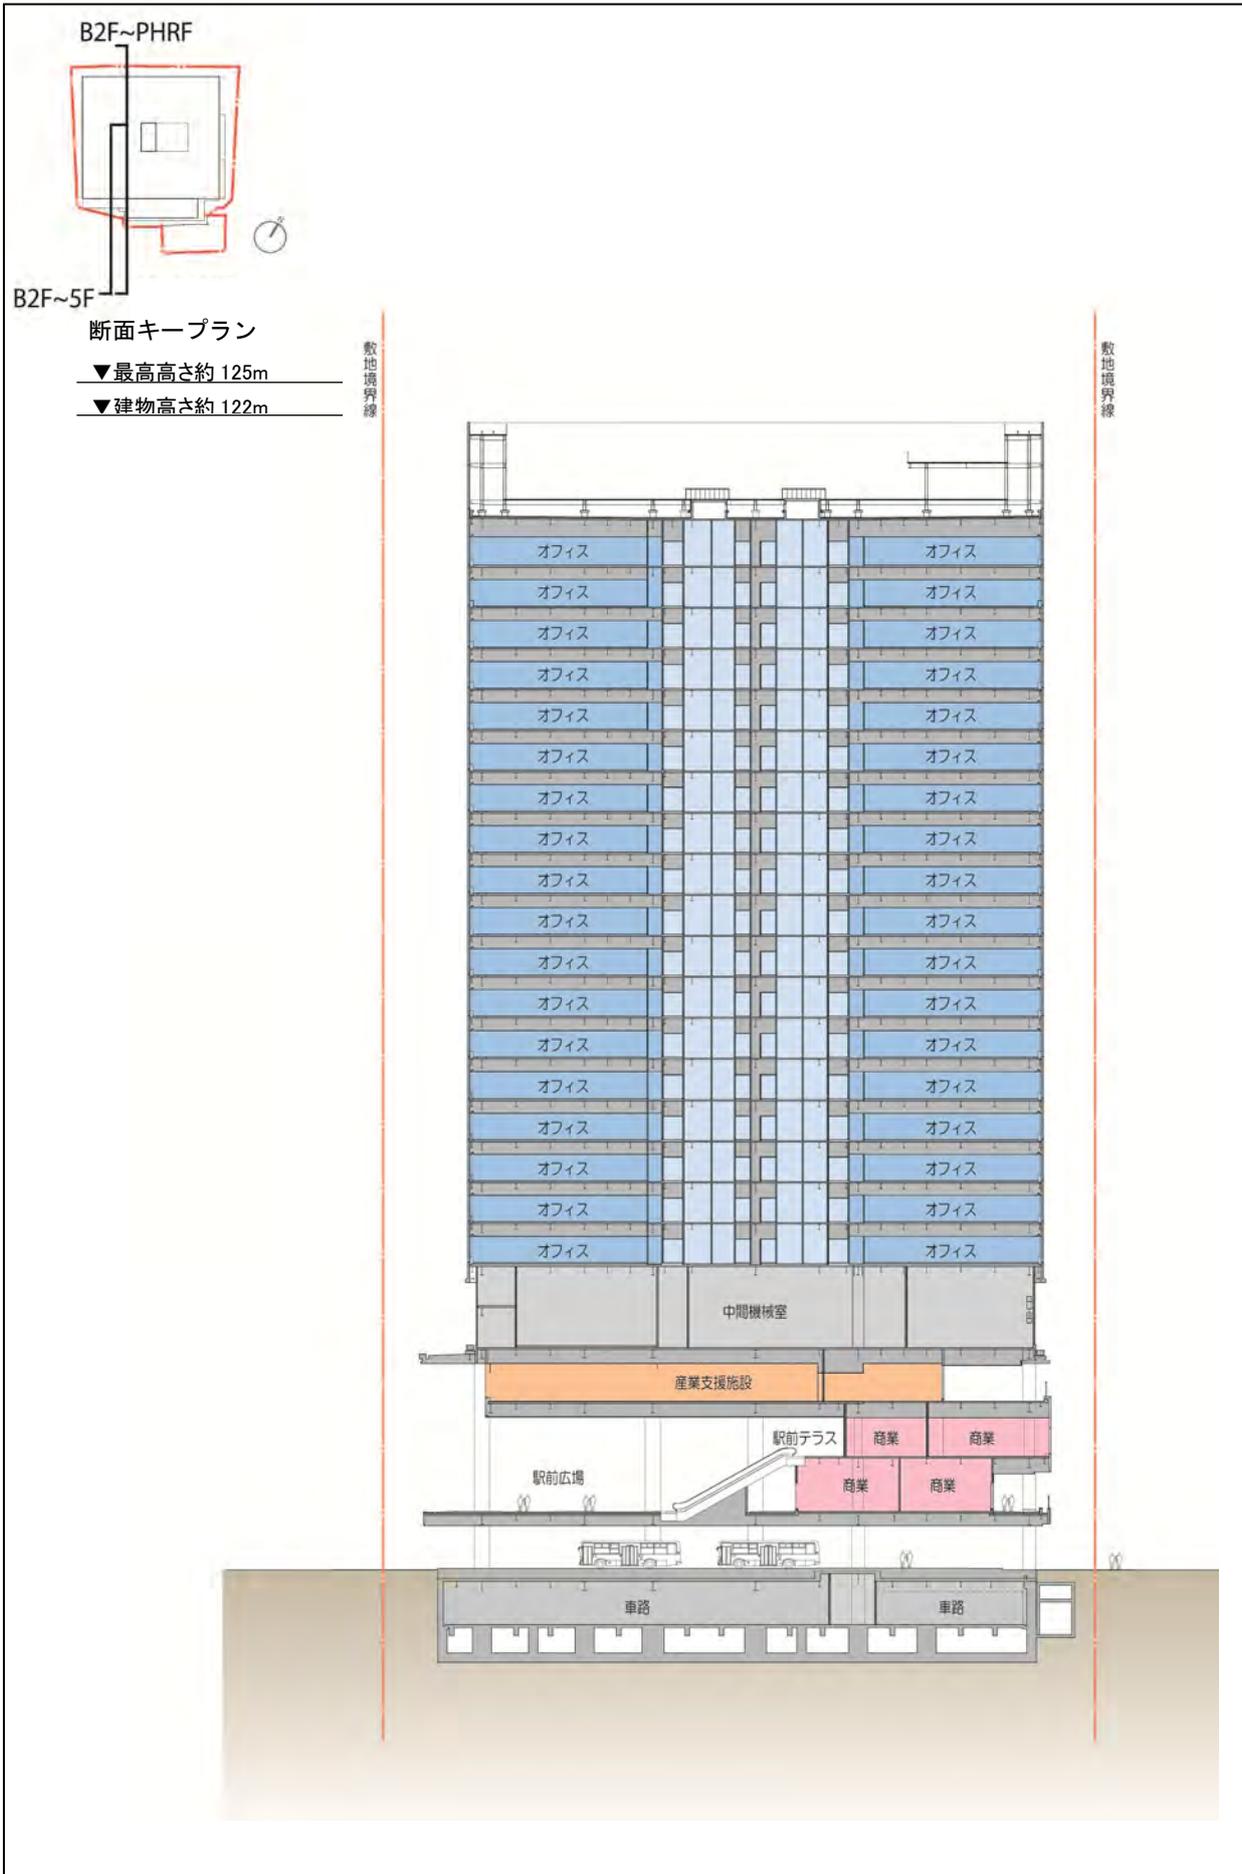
(2) 断面図 (S=1:800) 2-2 断面
